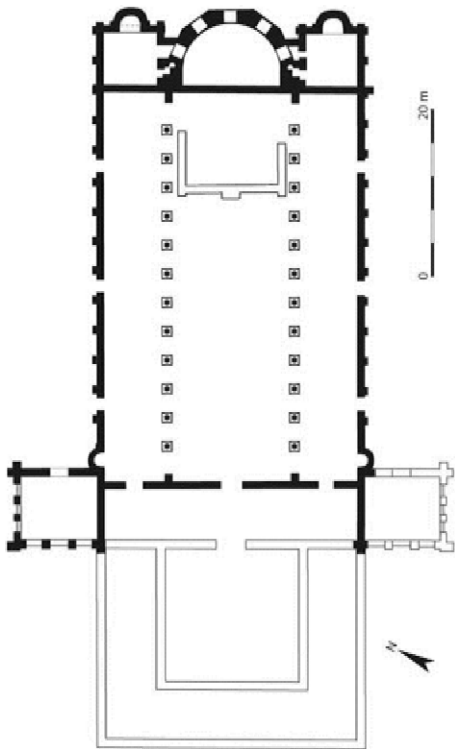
Grundriss – Sant' Apollinare in Classe
